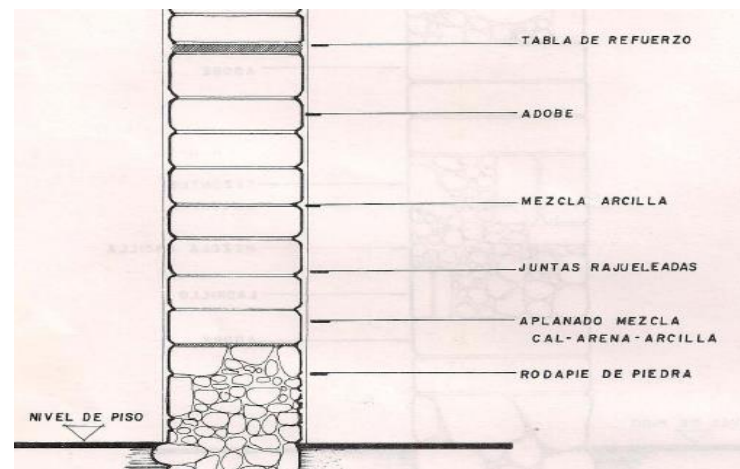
Detalle en mamposteo de piedra donde se aplica el aplanado de cal-arena.
